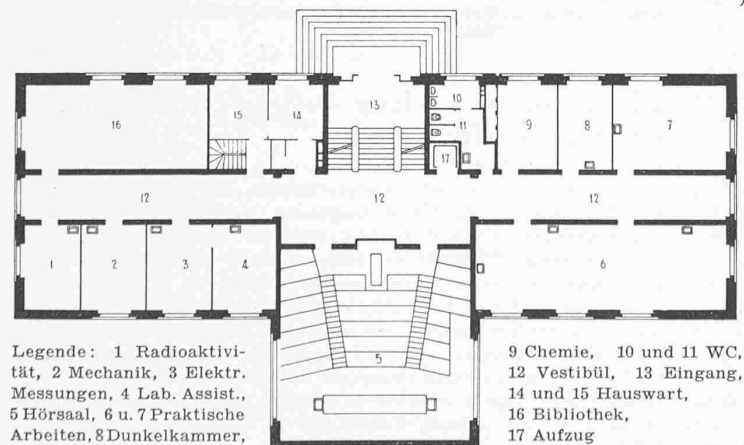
Grundriss vom Erdgeschoss 1:400
